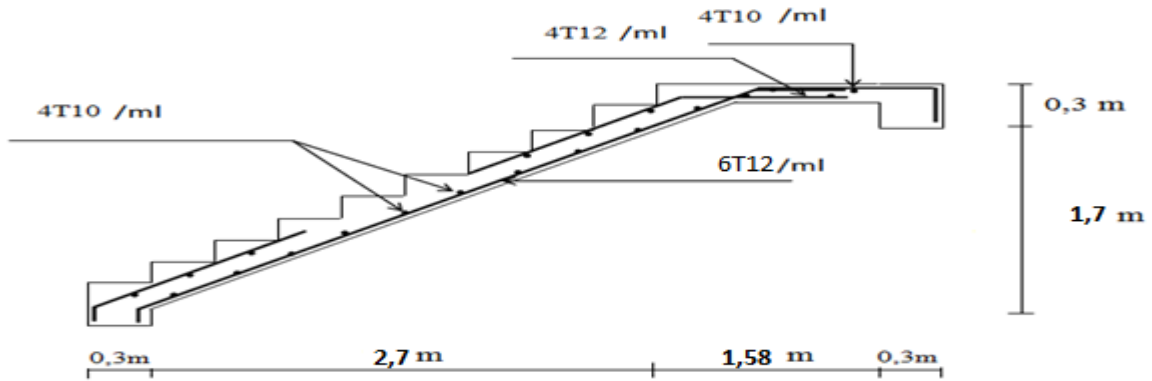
Schéma de ferrailage de l'escalier type 1 (cas volée 1).
